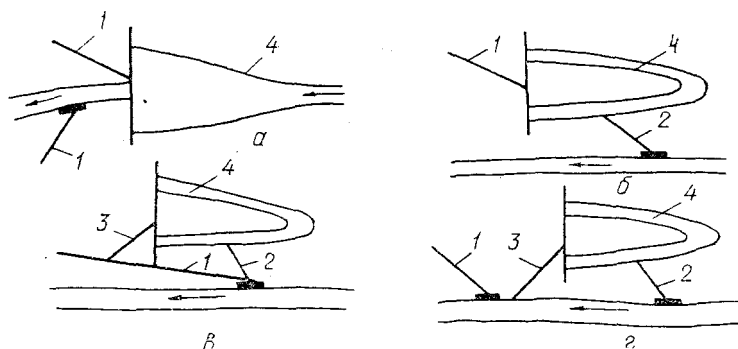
Схемы расположения регулирующих водохранилищ:
